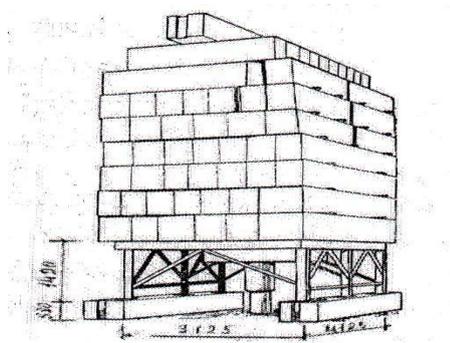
Загальний вигляд платформи для завантаження фундаментів гідродомкратами. Загальна маса фундаментних блоків 180 т, маса платформи 1650 кг
